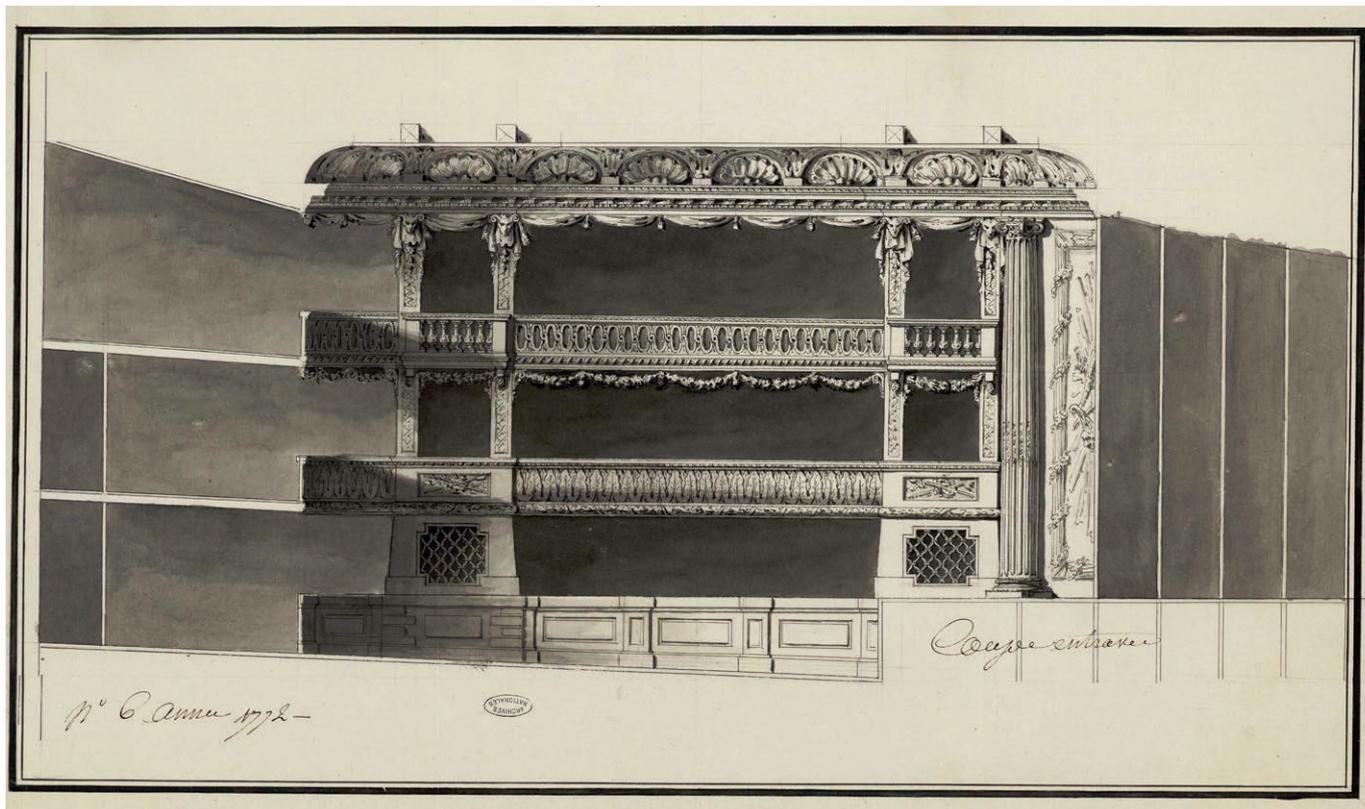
Planche A.N. N/III/Seine/262/7. La coupe longitudinale de FSG-GUI est dessinée et ombrée avec soin.
